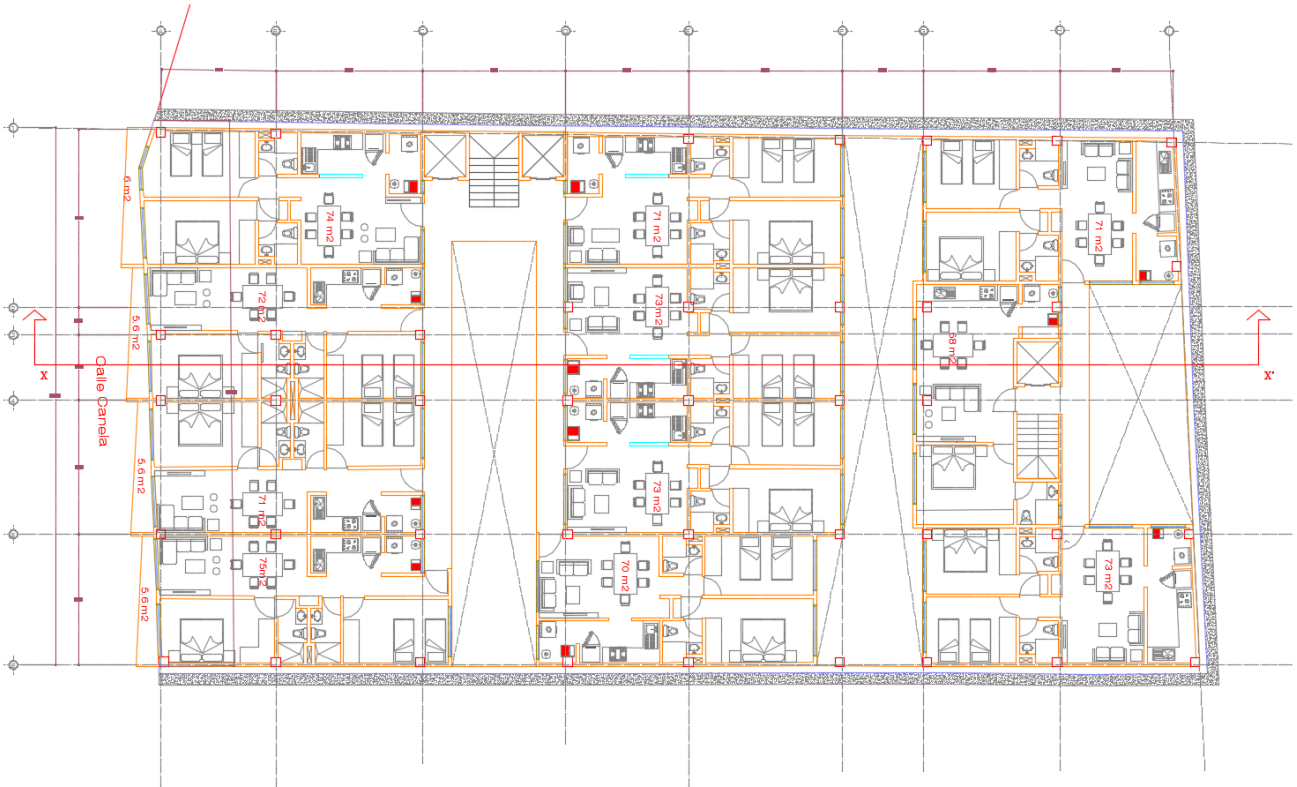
PLANTA ARQUITECTÓNICA PLANTA TIPO 3, 5 y 7
